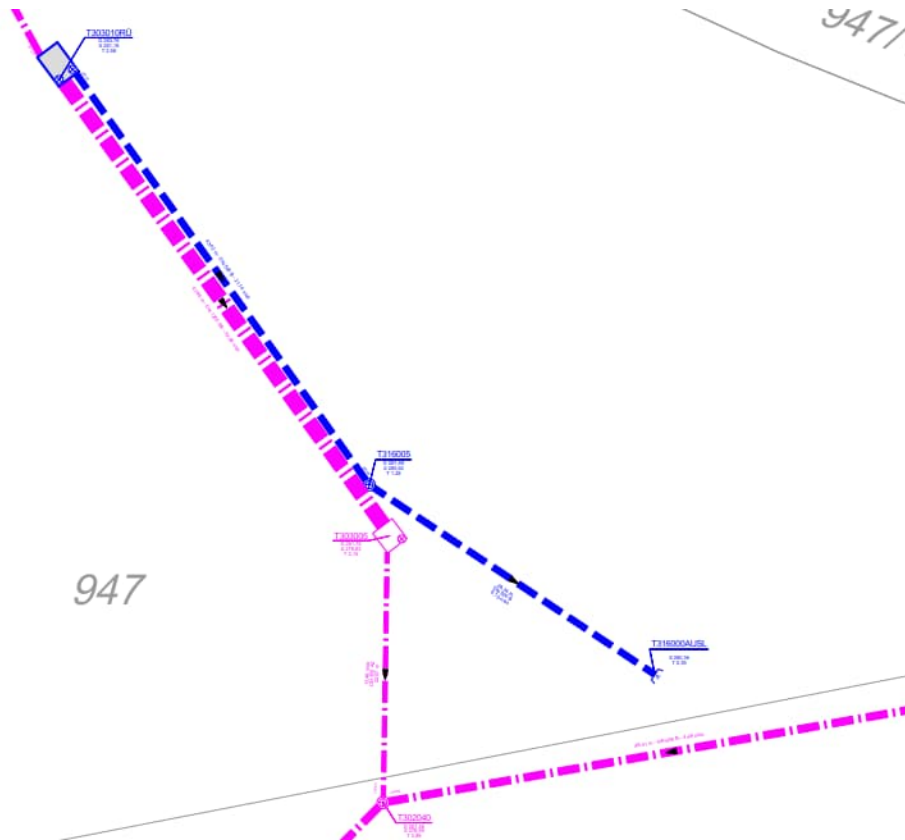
Lageplan SRK 2 Tambach Wildpark
